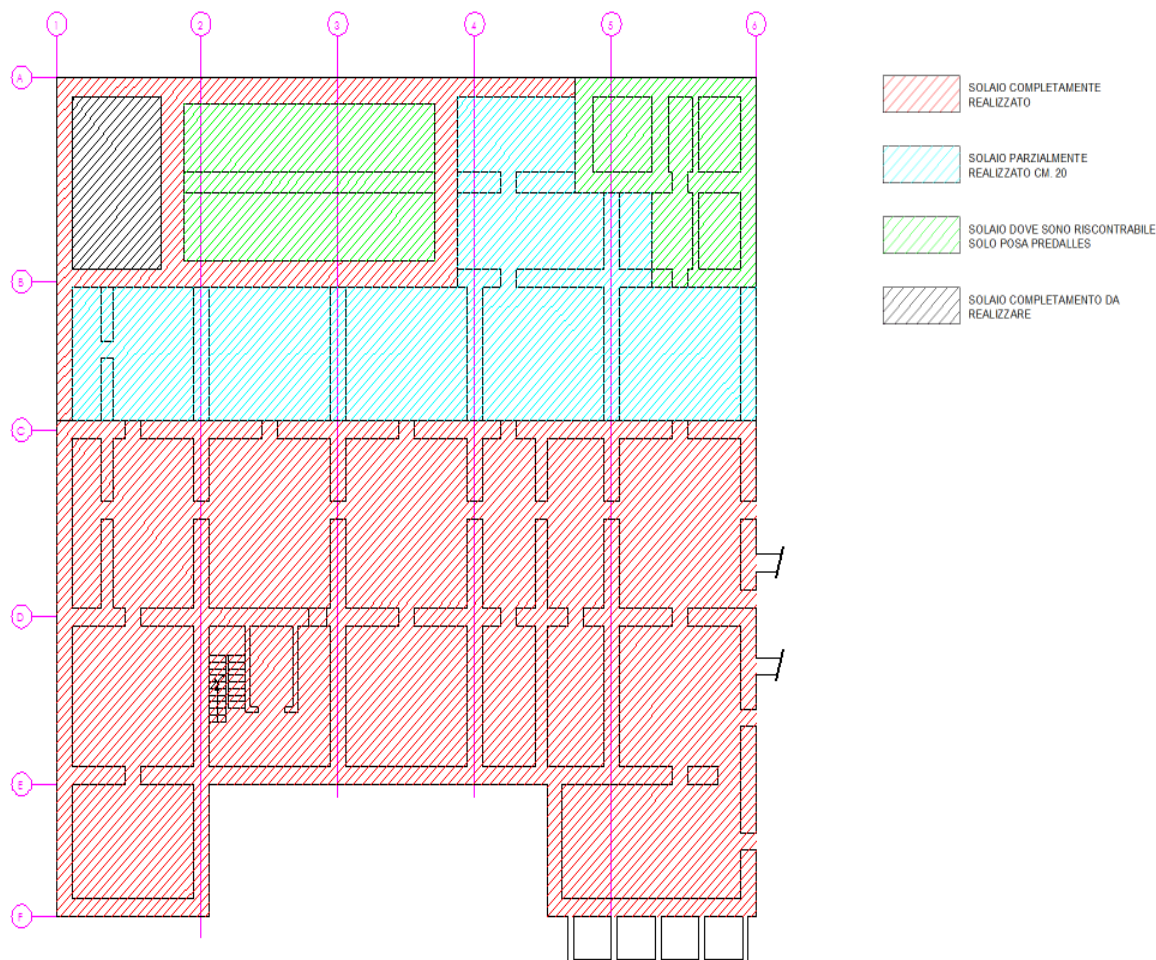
Planimetria stato di realizzazione del solaio dell'edificio di processo
